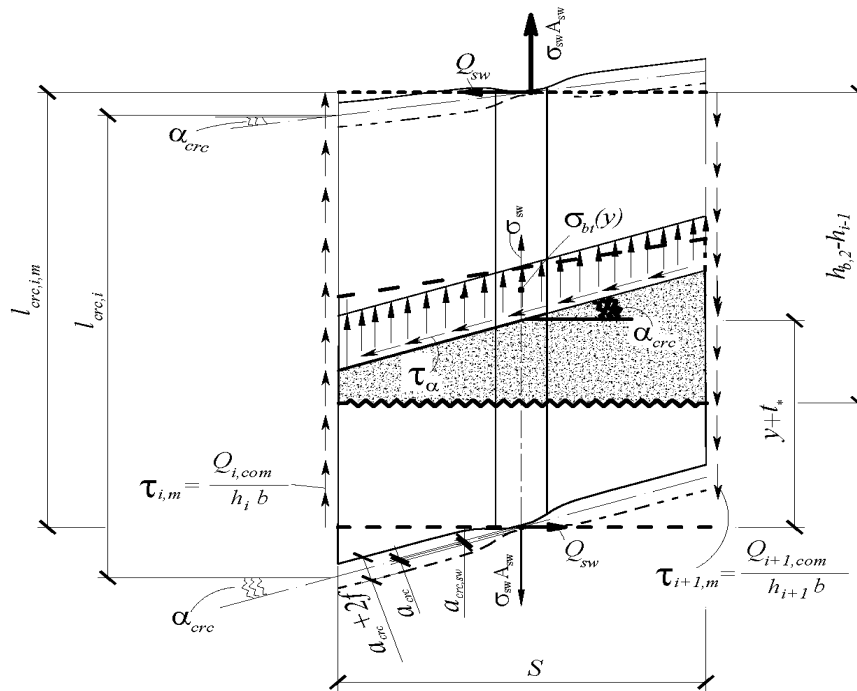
Упрощенная расчетная схема к определению деформаций растянутого бетона $\varepsilon_{bt}(y)$ между наклонными трещинами первого и второго типов в железобетонной составной конструкции
